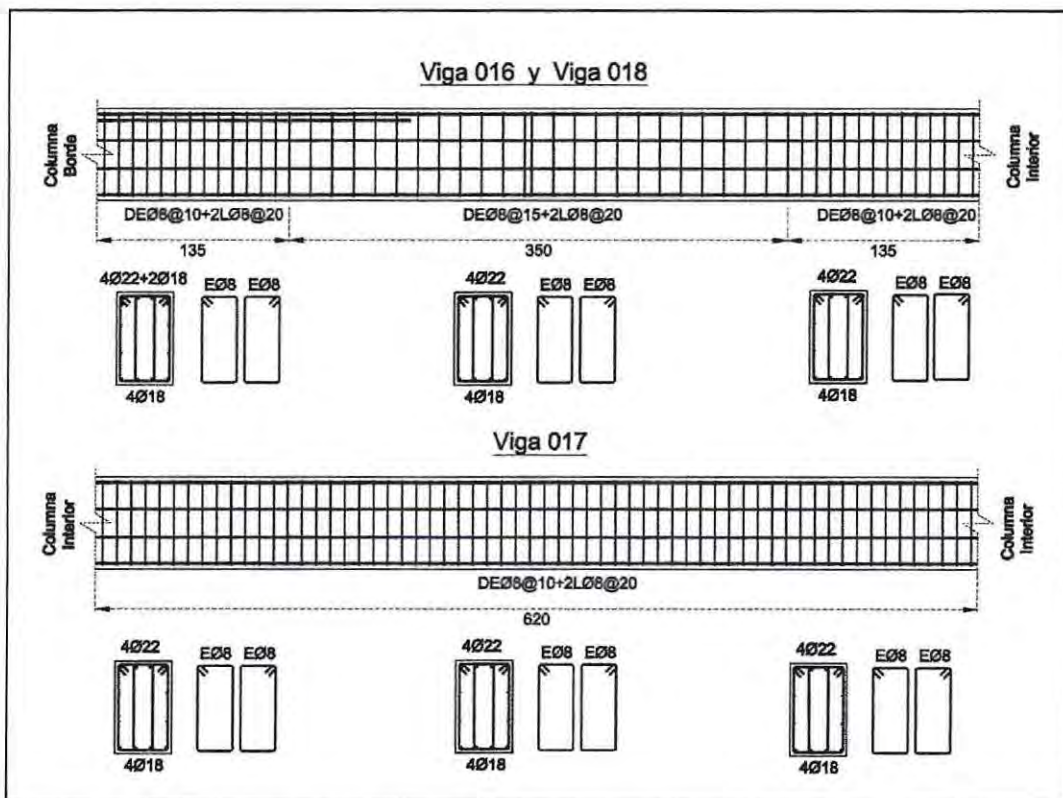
Distribución armadura de corte en vigas Eje A, estructura mixta.
